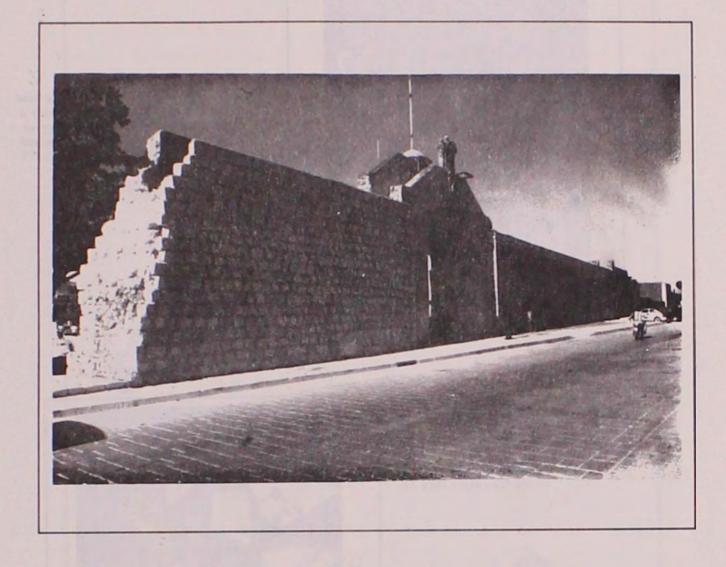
Panorama que presenta la muralla después de los trabajos de reconstrucción.
